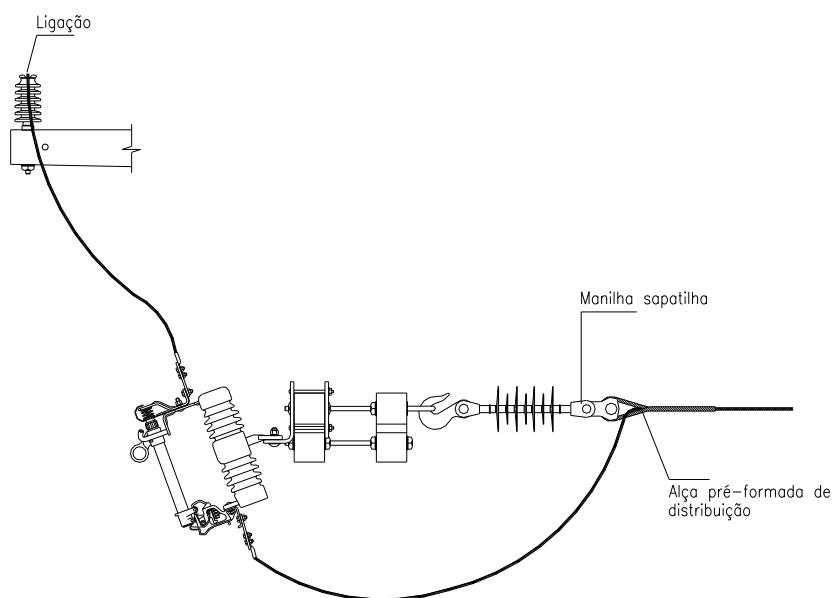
Amarrações e ligações – Primário – Chave-fusível e chave faca em derivação
